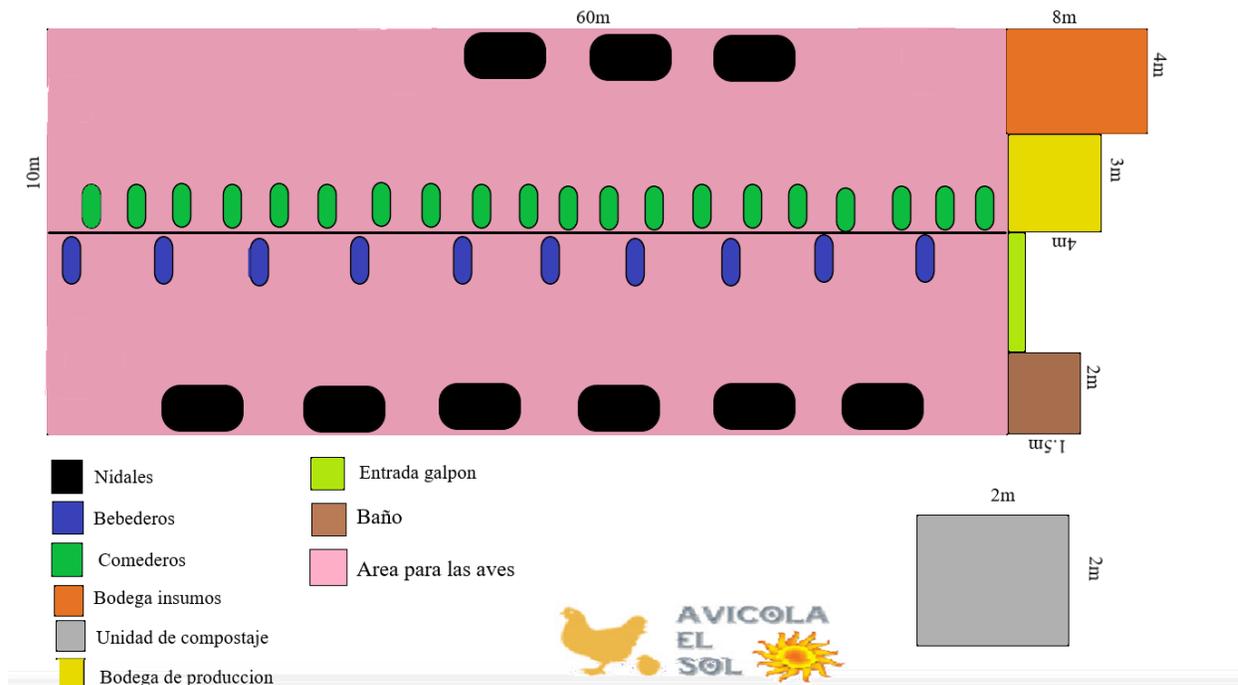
Distribución en planta de la avícola el sol. Fuente: Elaboración propia
